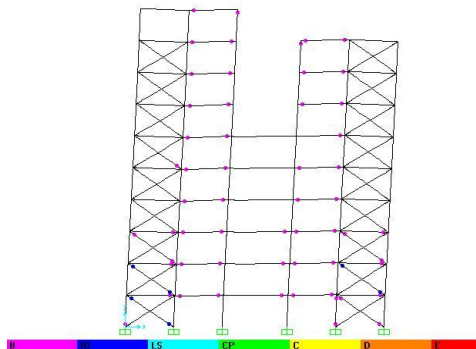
SRBE lantai 7 arah Y step 7 (Sumber Permodelan Sap2000)
